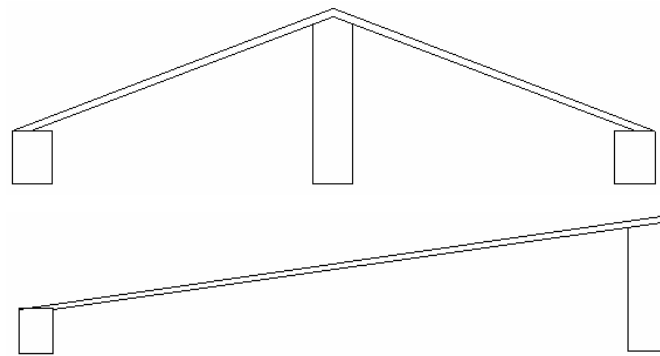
Cubierta estable sin viga de soporte. Fuente: Autores de proyecto.
